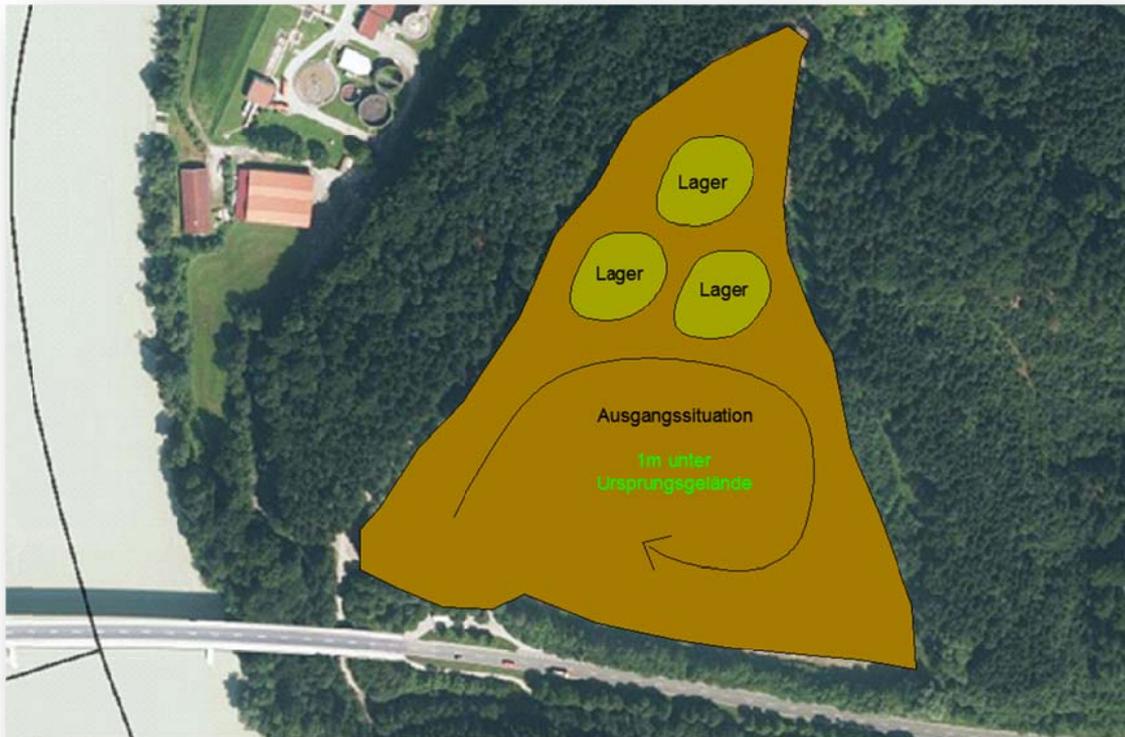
Schematische Grundriss-Darstellung der Ausgangssituation Anfang 2016
